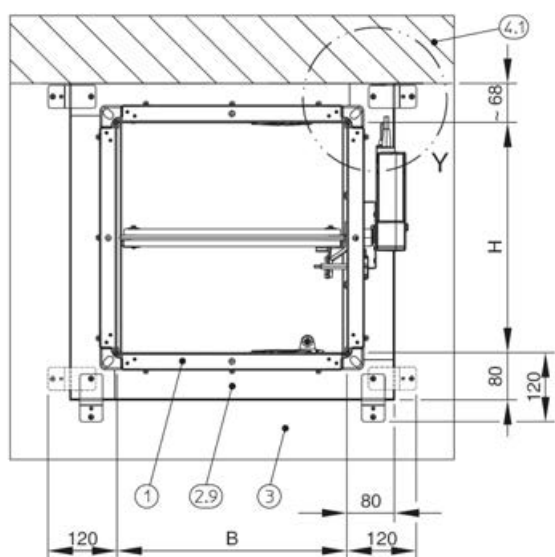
Kit d'installazione – spazio libero, per installazione vicino al pavimento o al soffitto
